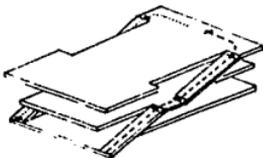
RAMPAS RECTAS ENTRE MEDIAS PLANTAS A ALTURAS ALTERNAS
